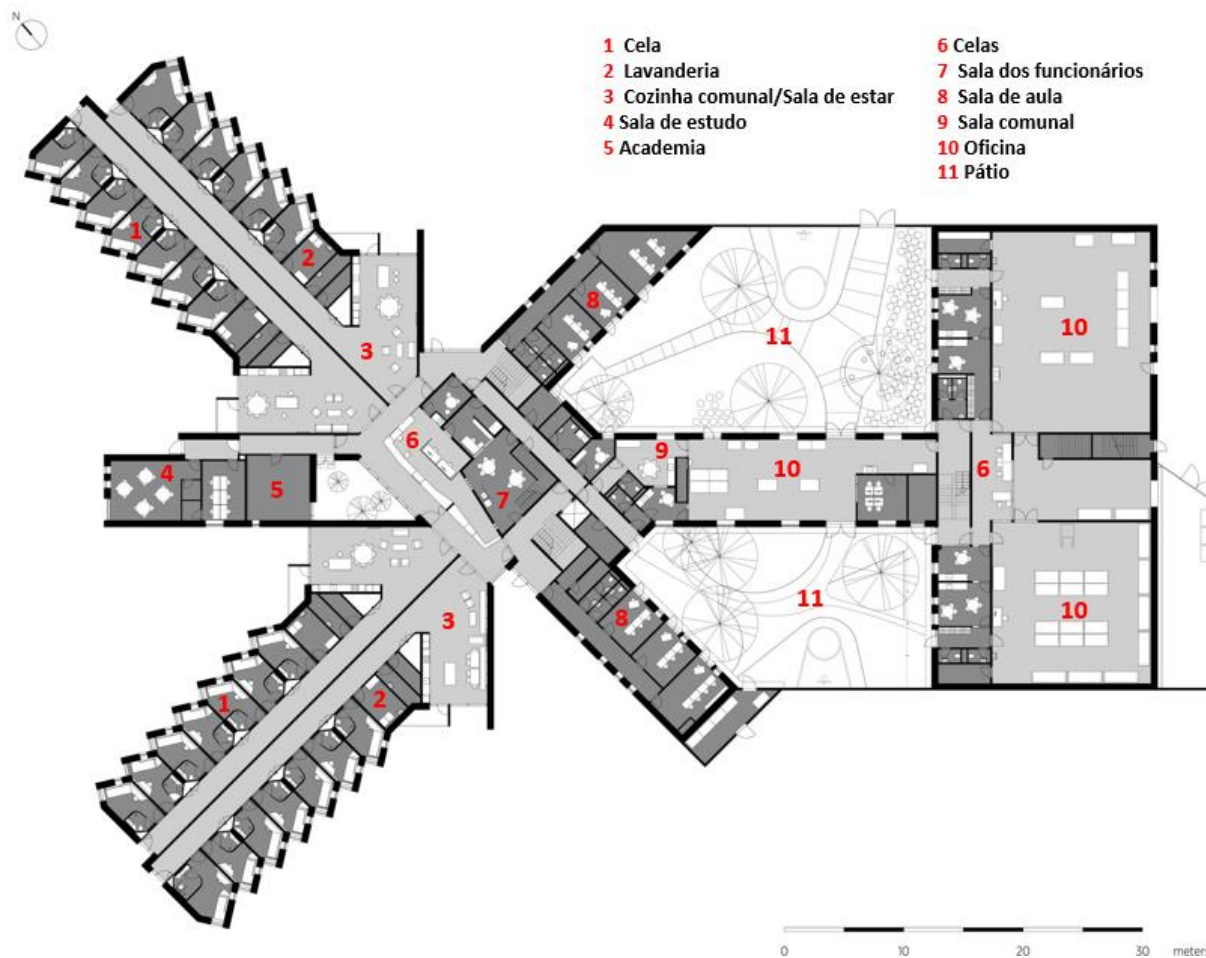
Planta de layout do piso térreo do edifício celas padrão com visualização dos ambientes - Fonte: MØLLER (2018)
